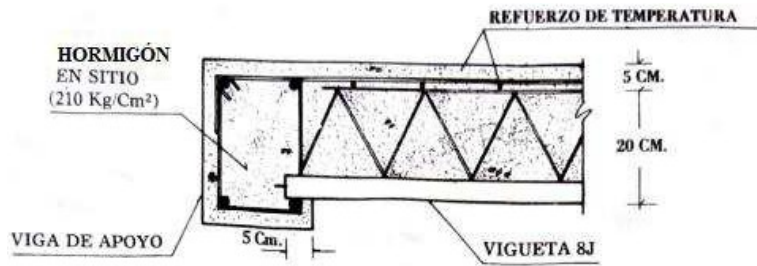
APOYO DE VIGUETA EN VIGA PRINCIPAL
